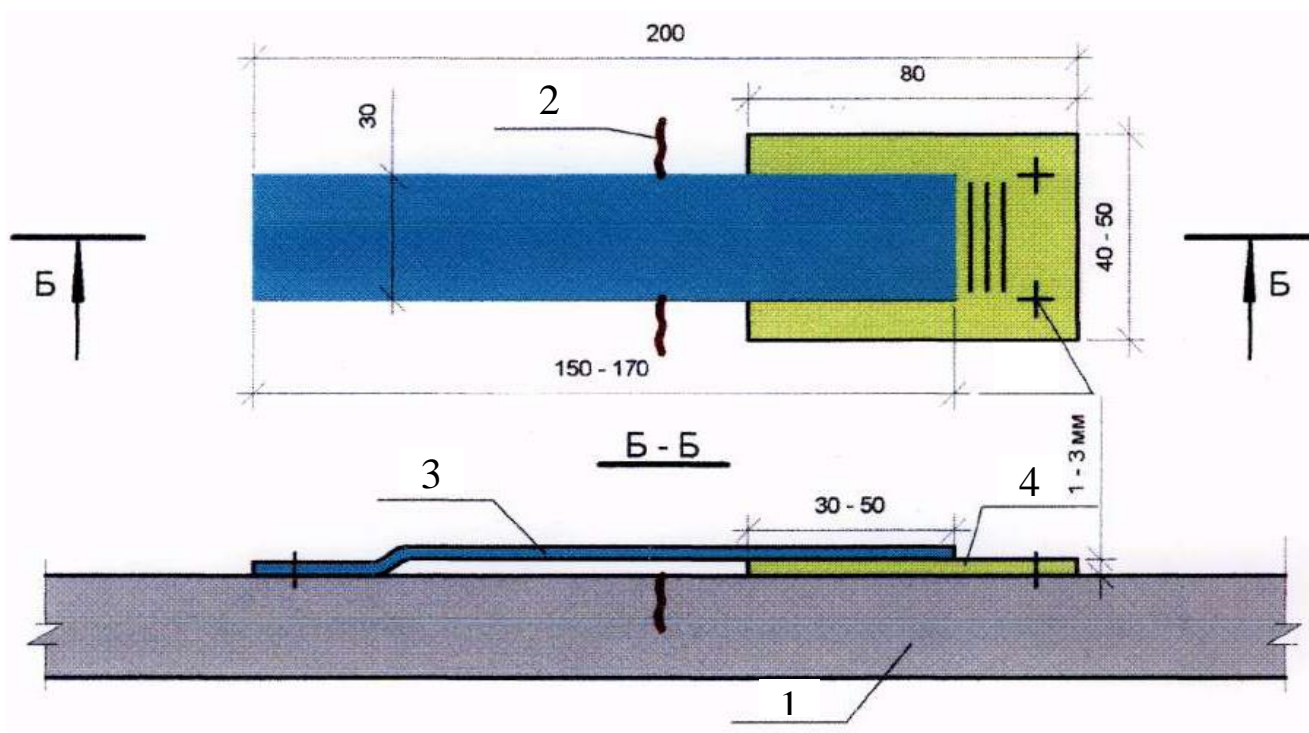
Конструкция пластинчатого маяка из листового металла:
